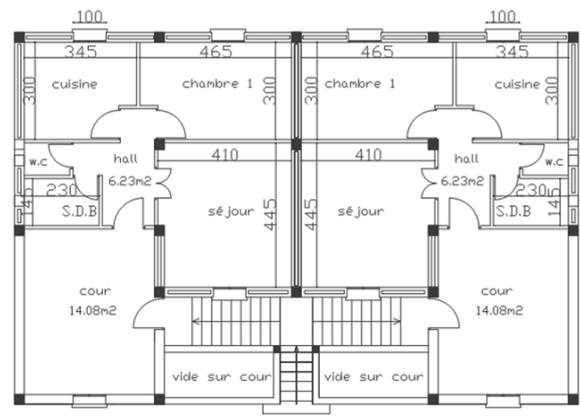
Habitations collective & individuelle en Structure poteaux-poutres-voiles (Source : Auteur)
